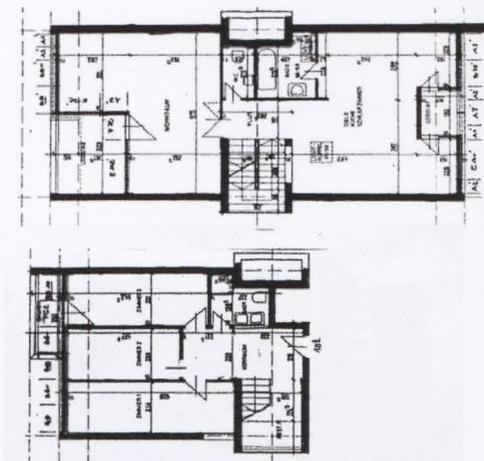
Terrassenhaussiedlung, Grundriss Typ t
